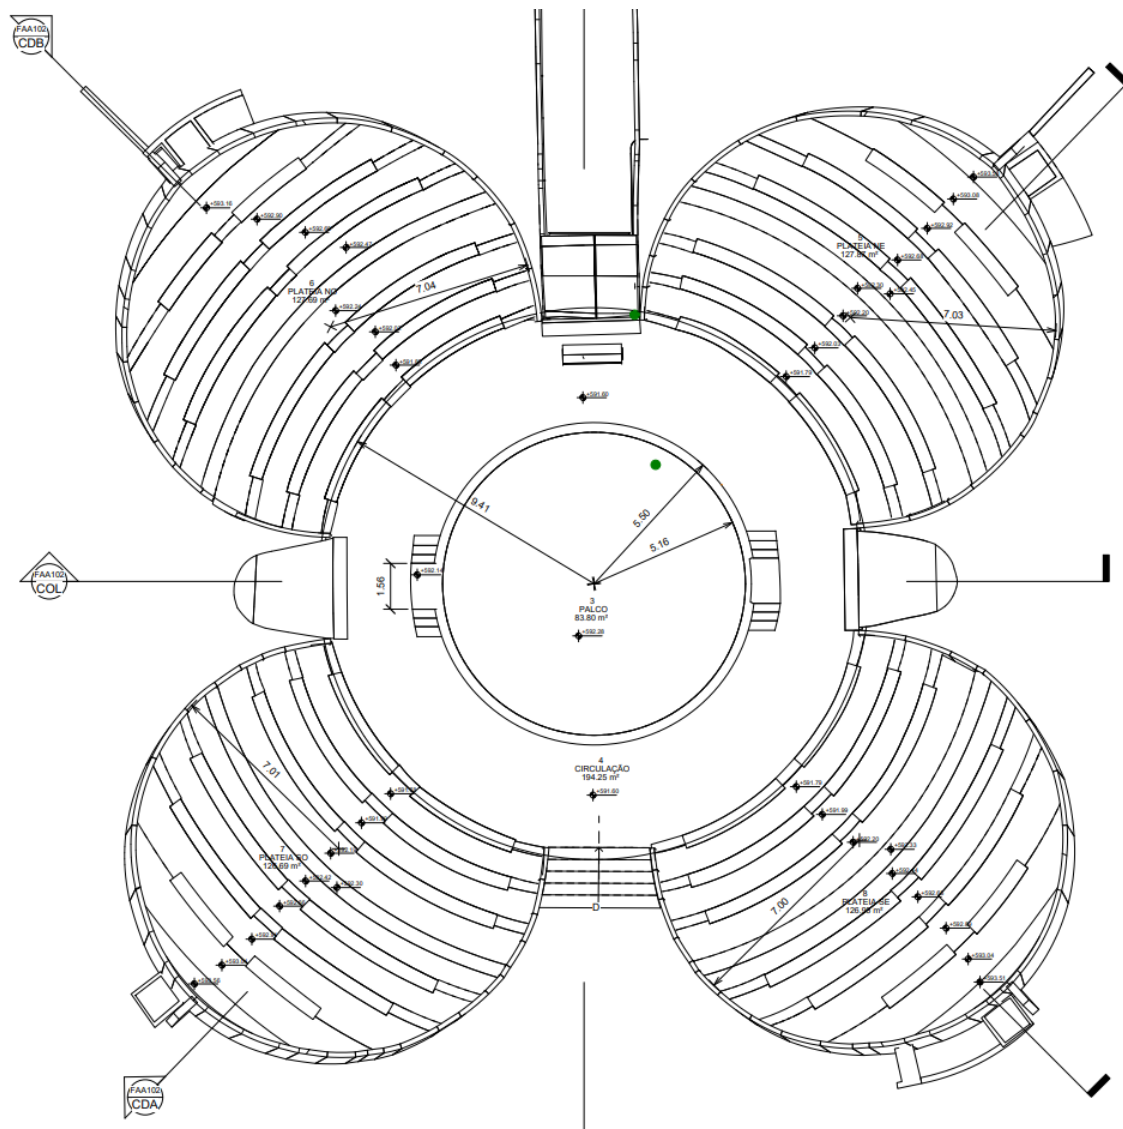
Planta baixa do Teatro de Arena da Unicamp.
